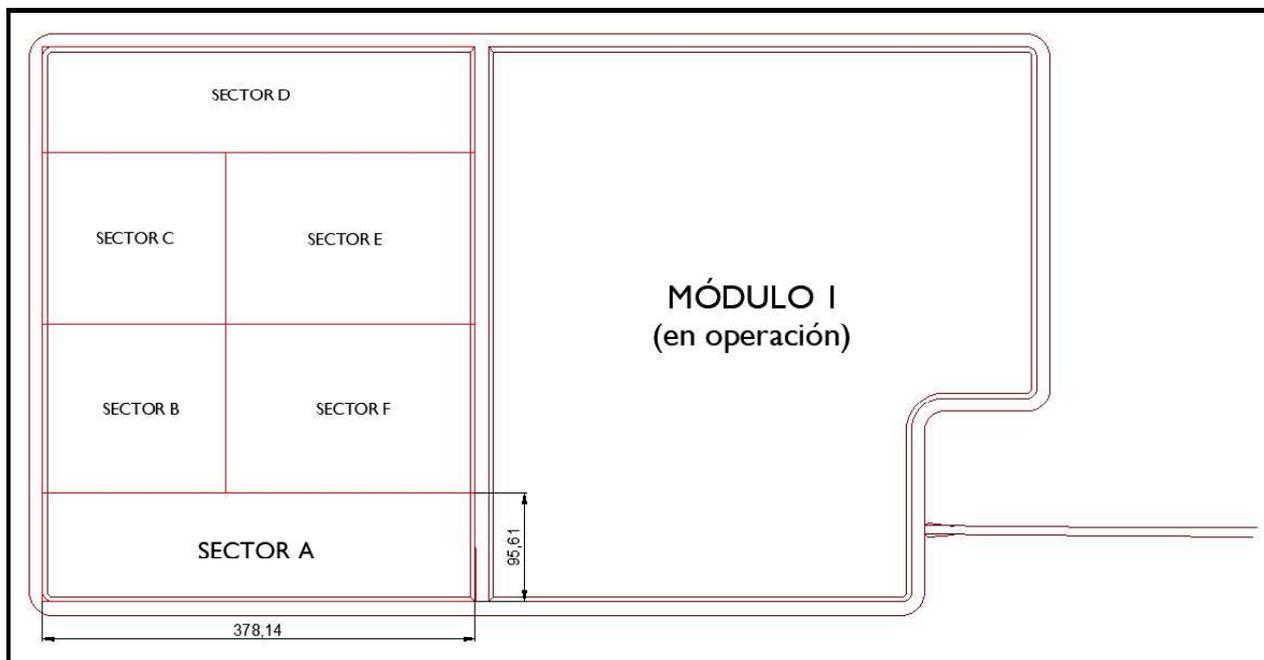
División Sectores Módulo 2 CDF y detalle Sector A (a construir)
